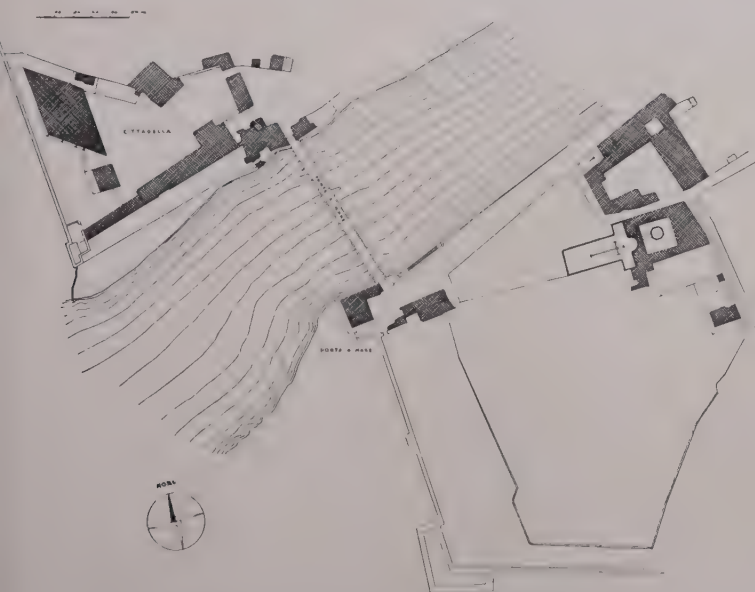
Planimetria generale della zona secondo l'antico catasto
